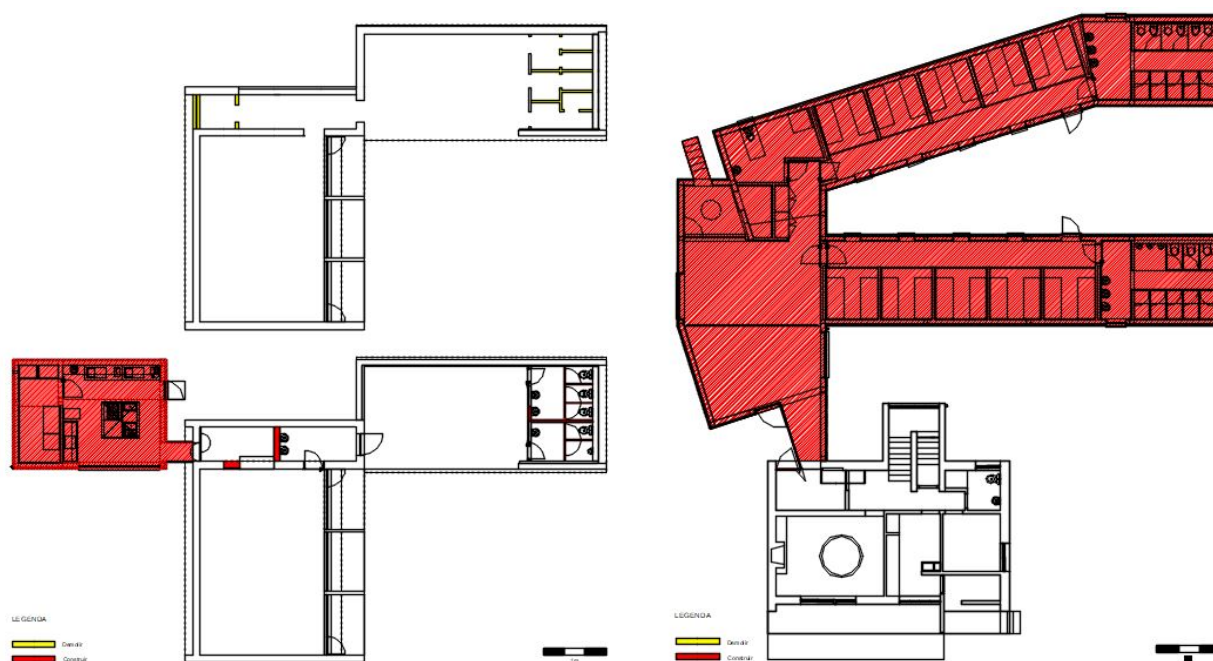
Edifícios B e C - Plantas de demolição / construção
